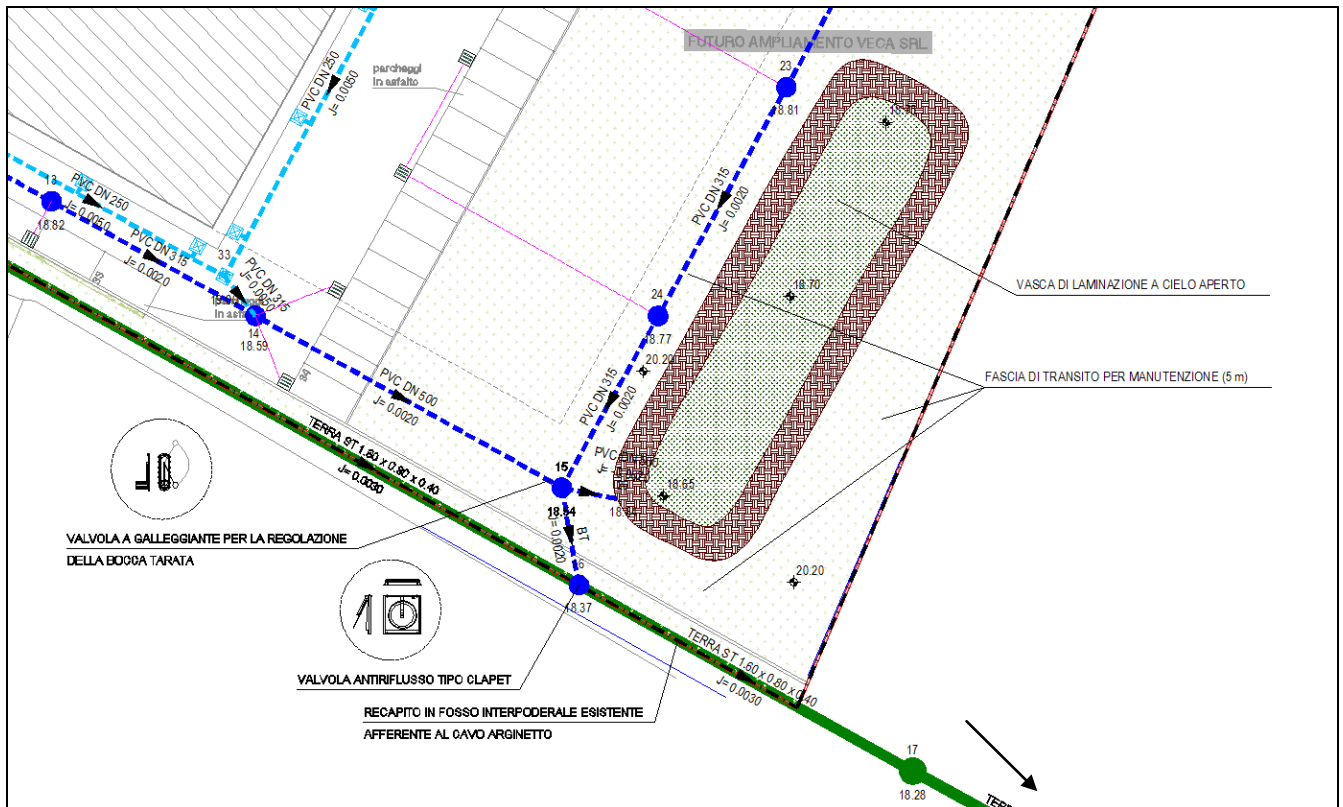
Localizzazione planimetrica della vasca di laminazione in oggetto.
